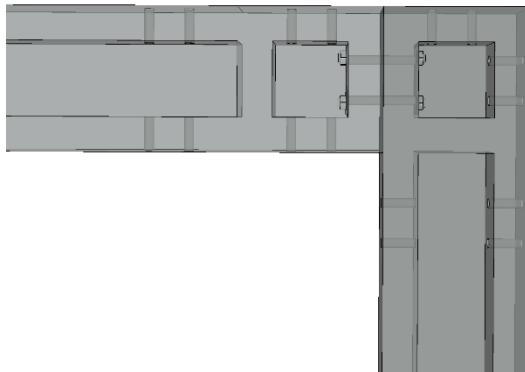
12 Hubungan balok dengan Kolom Tipe 1 3D
